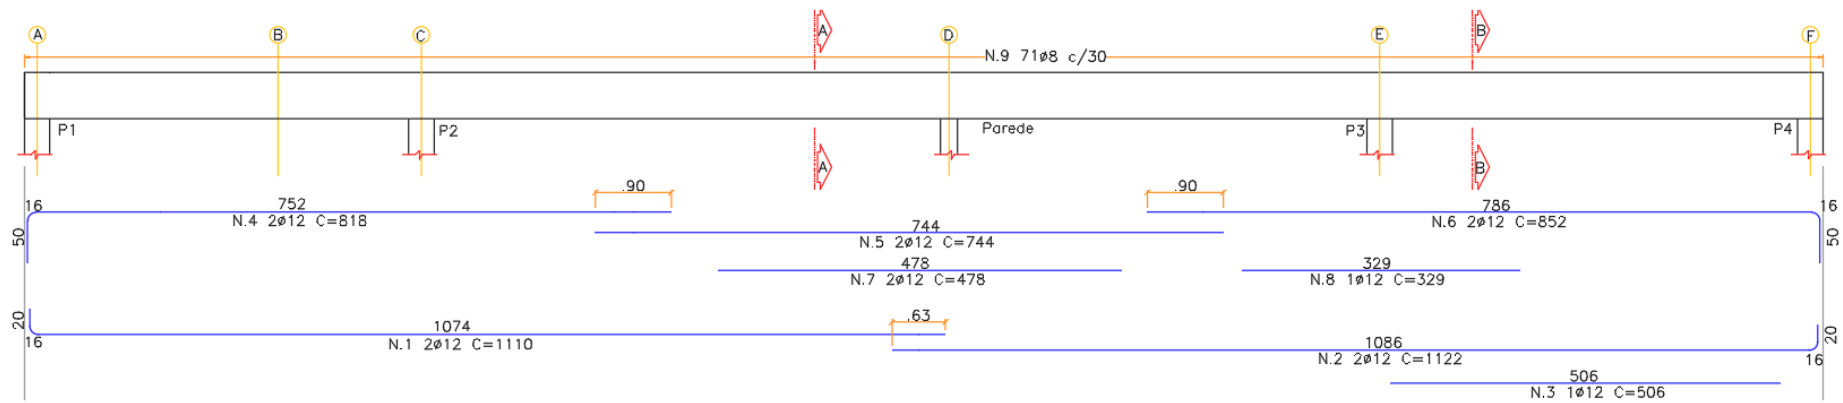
Armadura longitudinal V2-1, cálculo manual.
